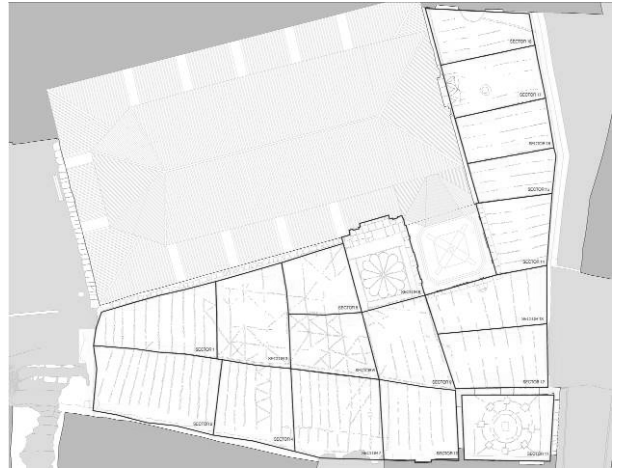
Esquema de la distribución de la plaza por sectores para realizar el levantamiento pormenorizado de cada zona
